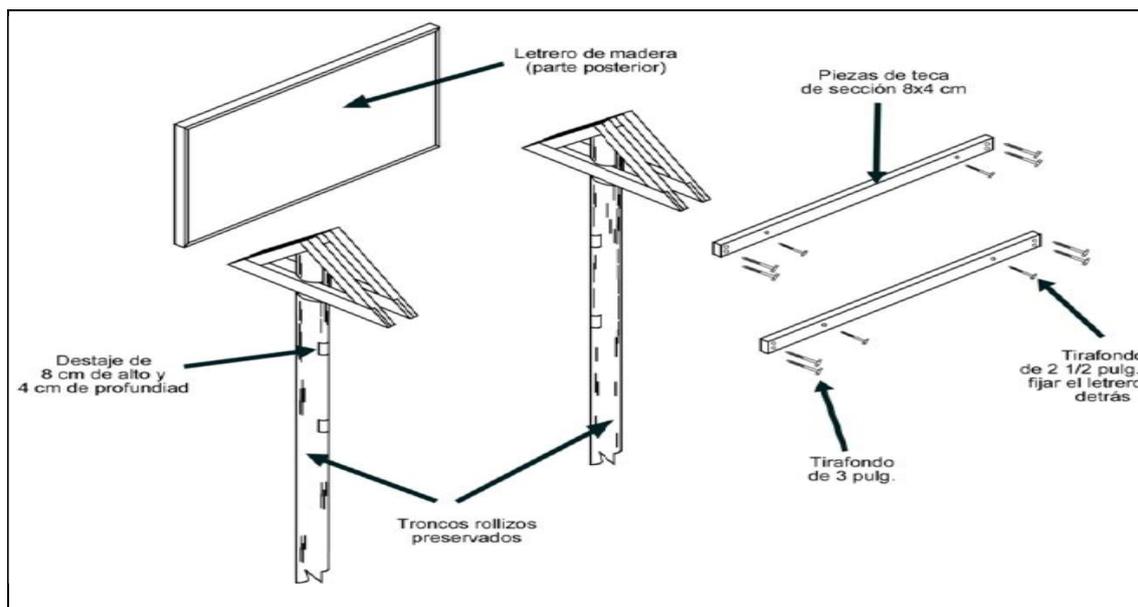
Detalle de la instalación del letrero de madera en su respectiva armazón
